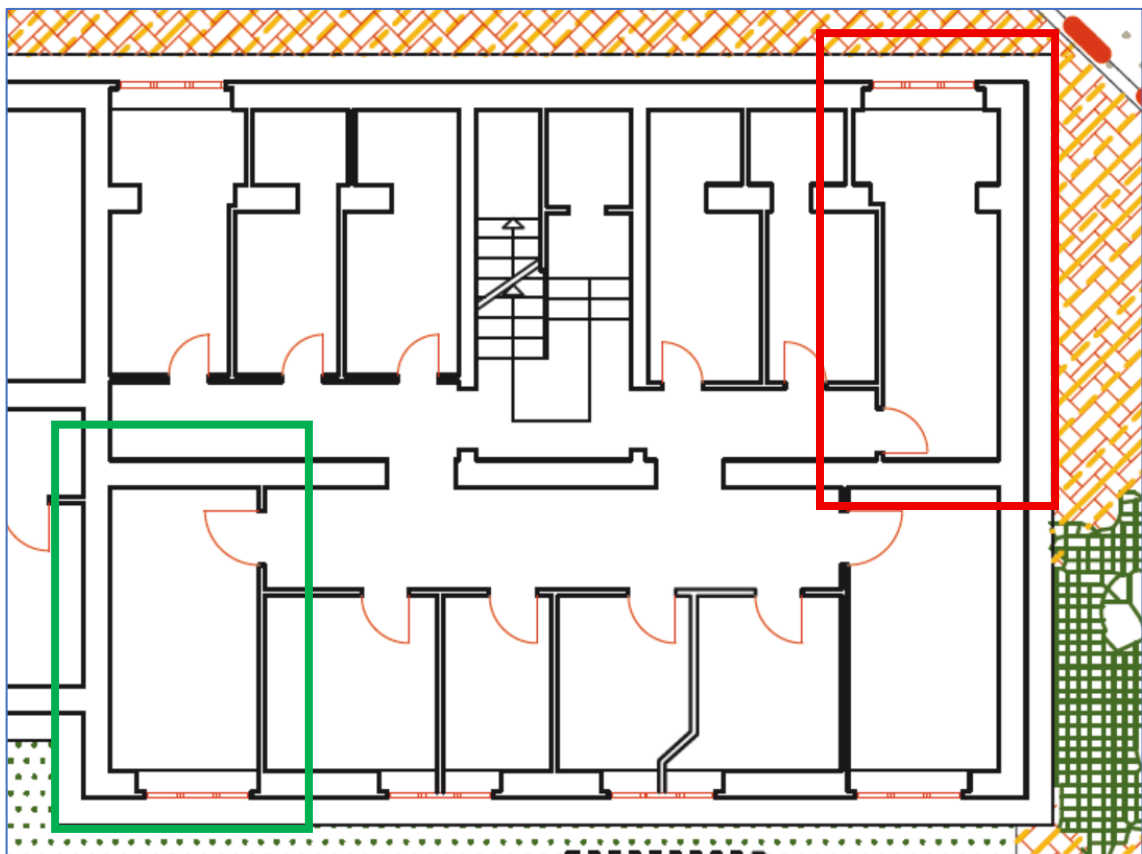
Estratto tavola progetto piano cantine SCIA 2023 - INDIVIDUAZIONE CANTINA
